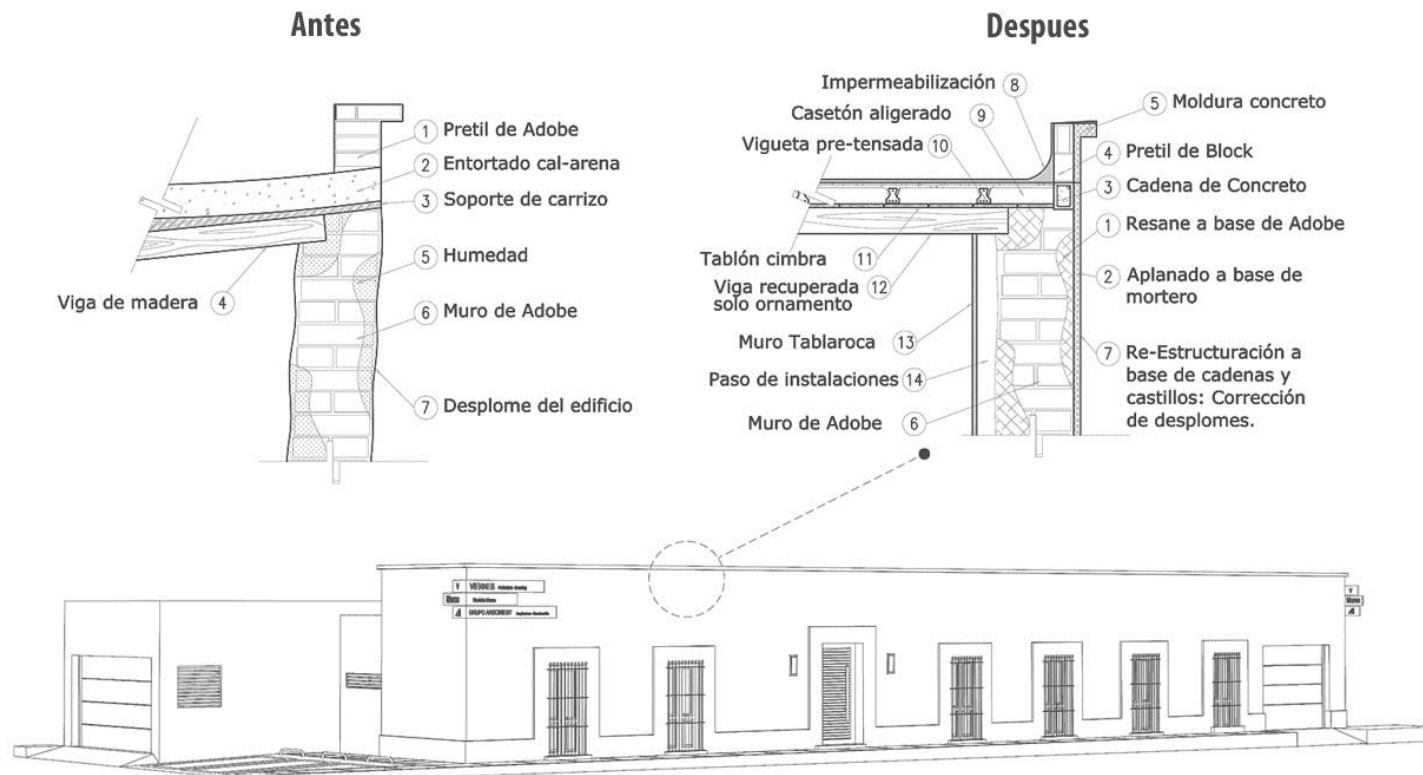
Corte por fachada - muros de adobe (Flores 2014)
